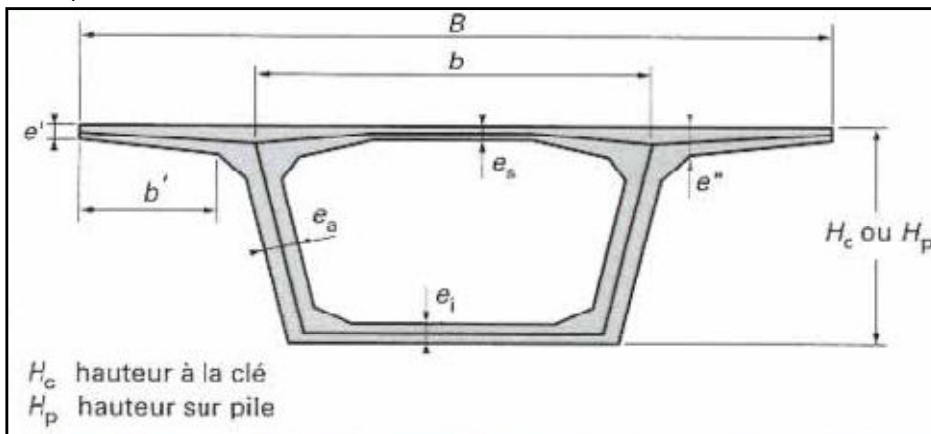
coupe transversale d'un voussoir préfabriqué
